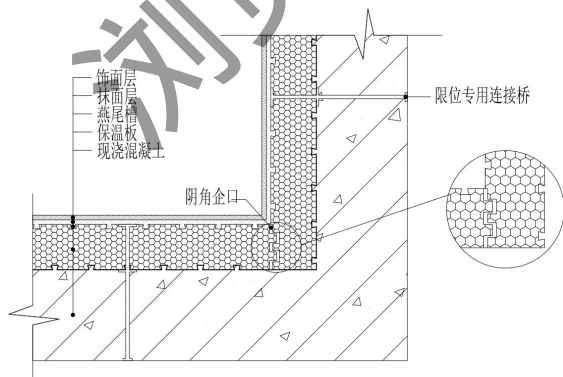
现浇混凝土大模内置保温系统阴角部位示意图
